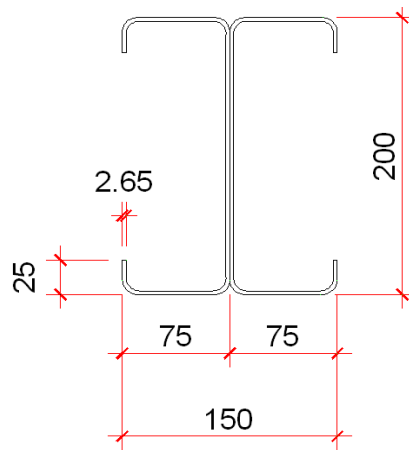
Seção transversal das vigas 2Ue 200x75x25x2,65
